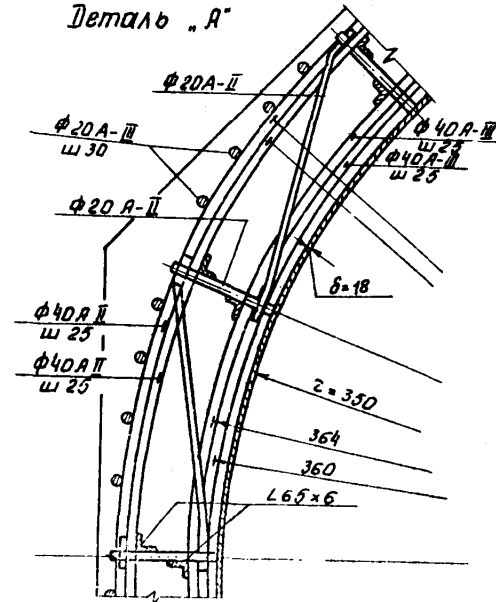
Сталежелезобетонный турбинный трубопровод на бетонной площадке.
